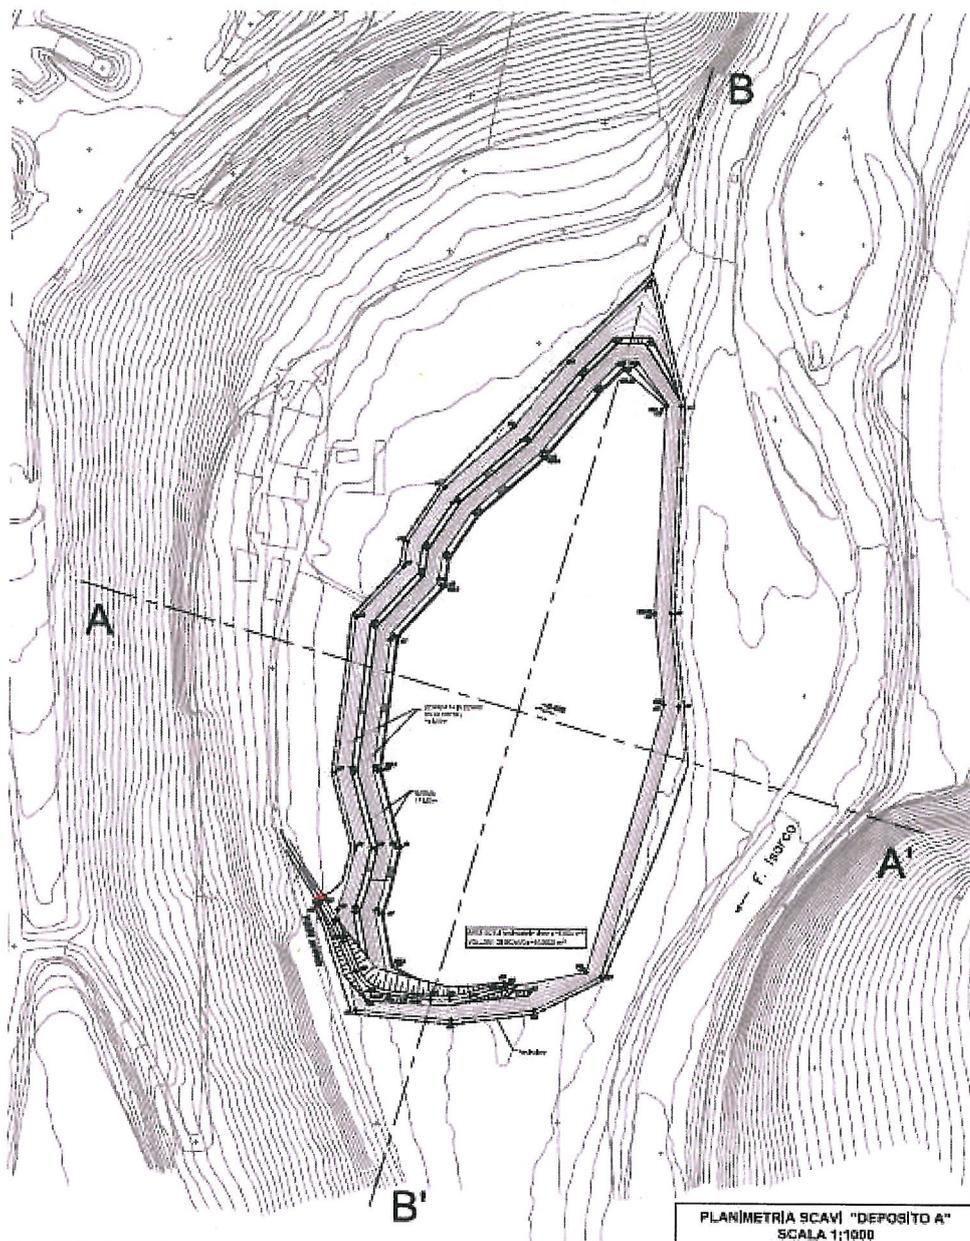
Depositi definitivi in Val Riga – A – Vorderrigger – Pianta scavi
